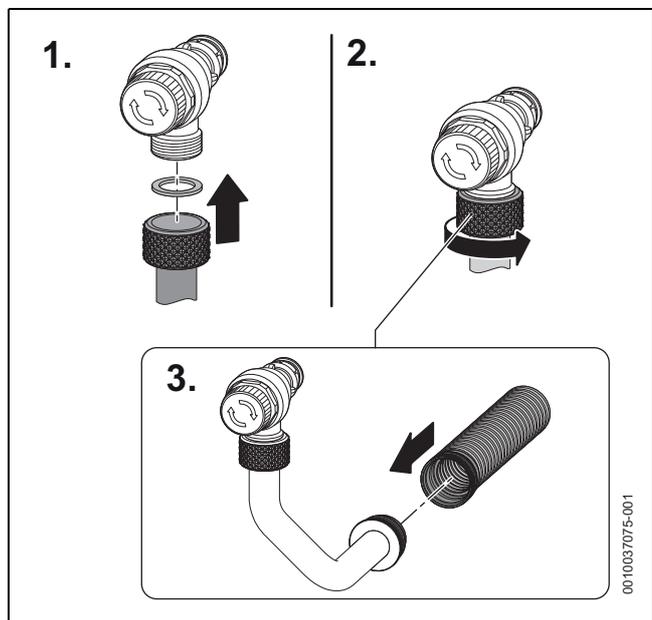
Montage du tube sur la soupape de sécurité (chauffage)
